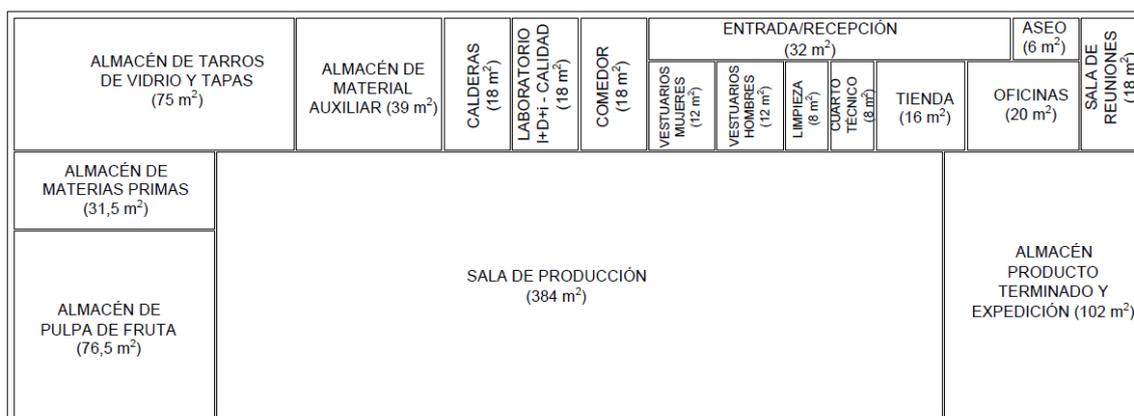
Croquis diseño en planta. (Fuente: Elaboración propia, 2018)
